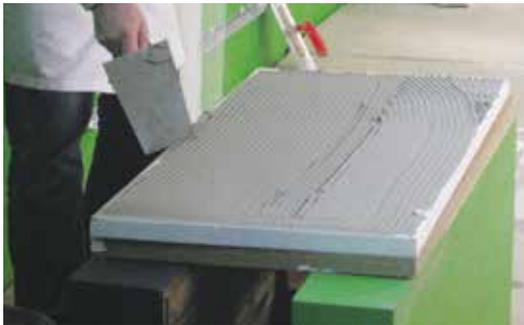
Aplicação da ARGAMASSA THERMINNOV por barramento total
